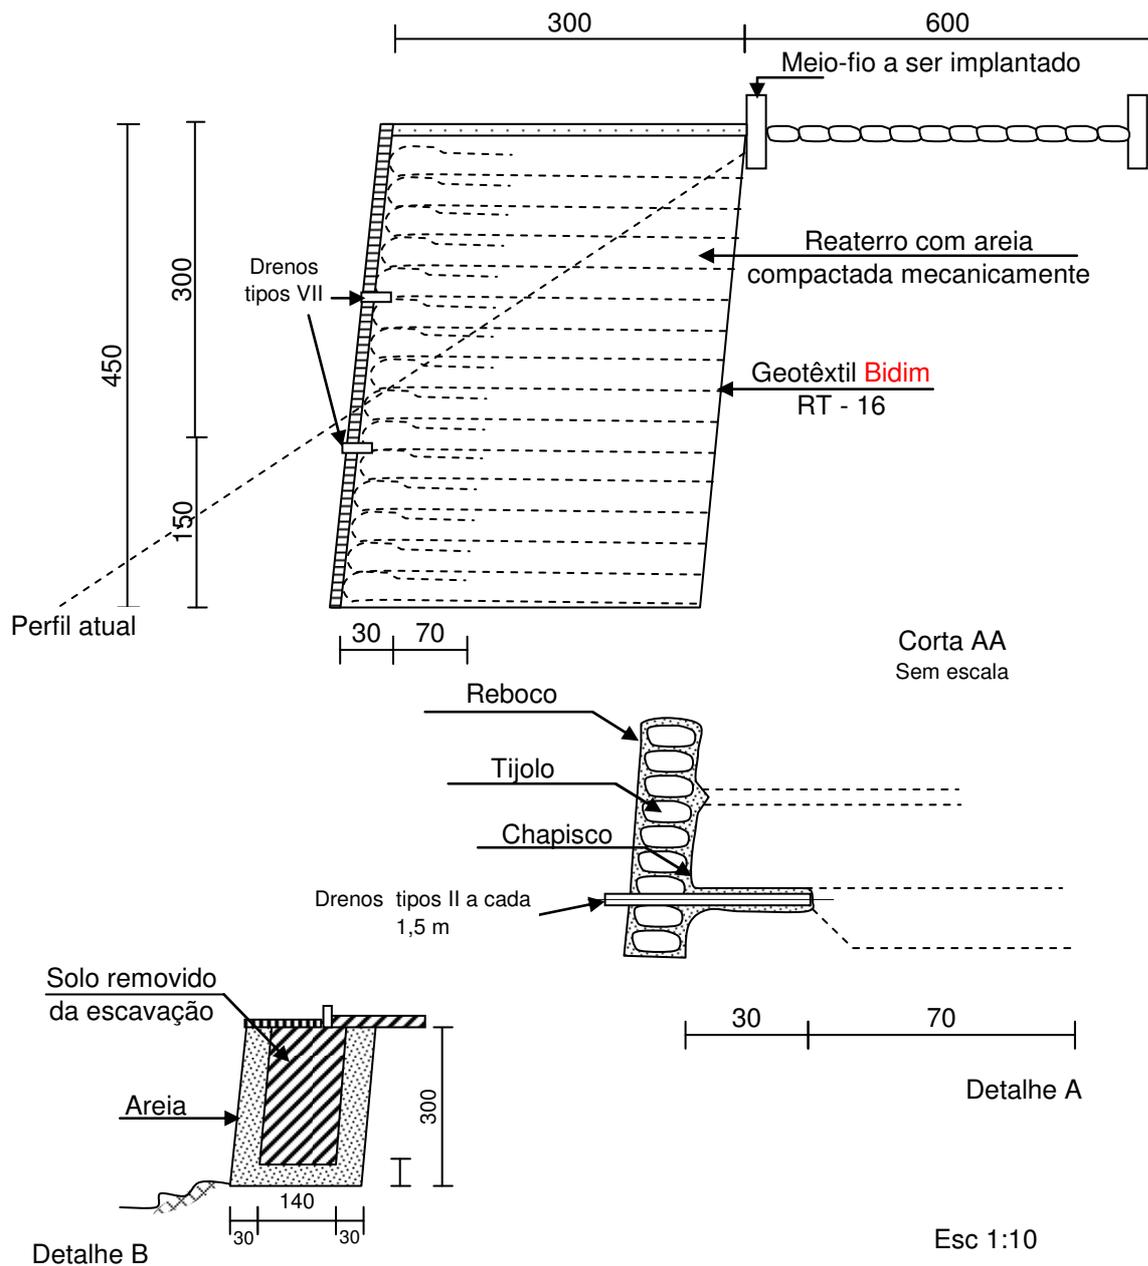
Corte e detalhes, Localizadas 1 e 3, Lote 2.
